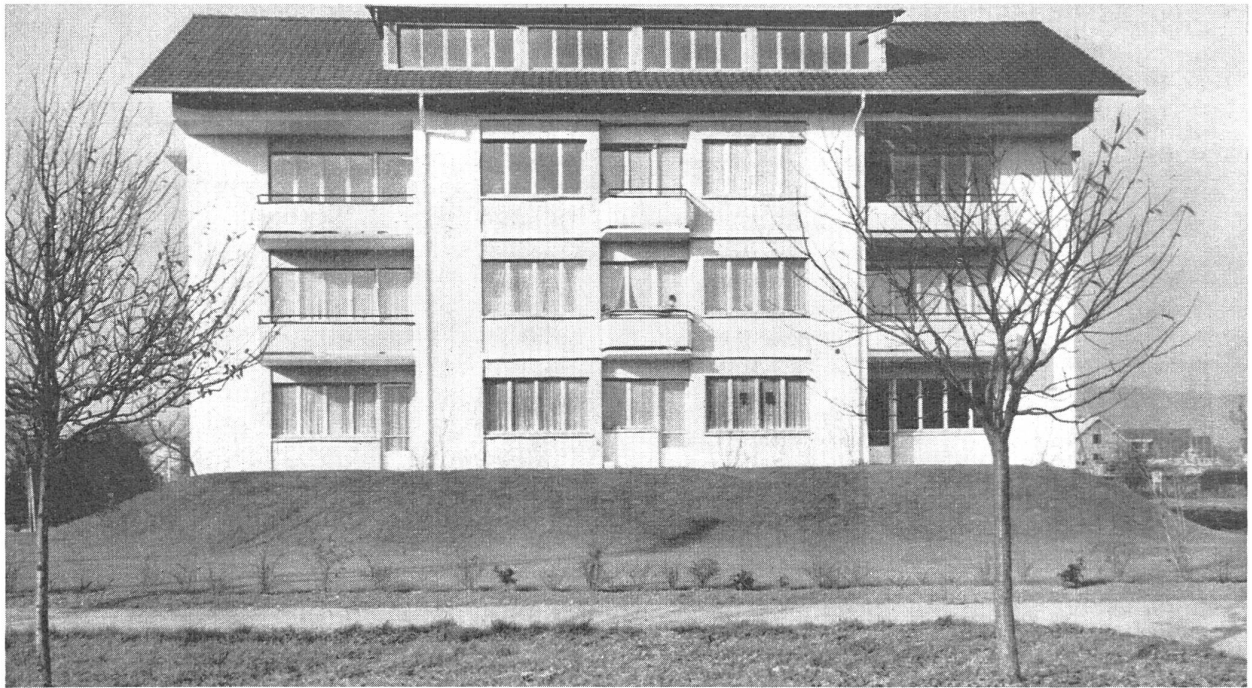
Die widerrechtlich ausgeführten Dachausbauten lassen das ursprüngliche Dach zur Attrappe werden.
